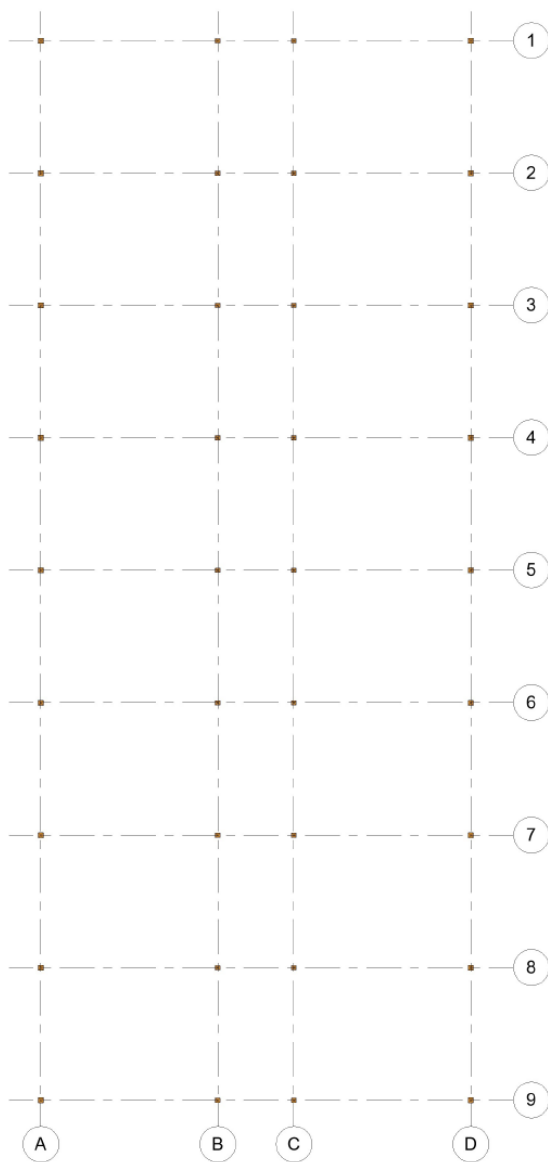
Aksekart plan 1 betong tildelt fra Veidekke
